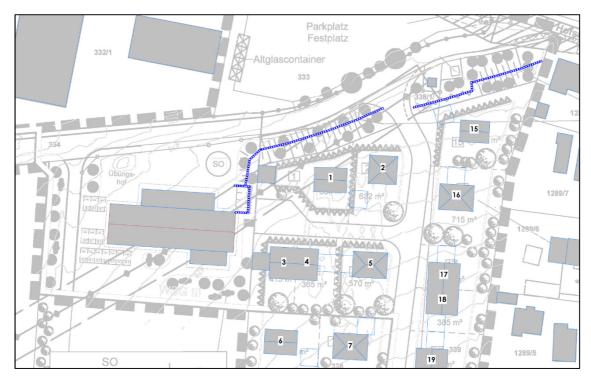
Lageplan mit Darstellung der erforderlichen Lärmschutzwände
